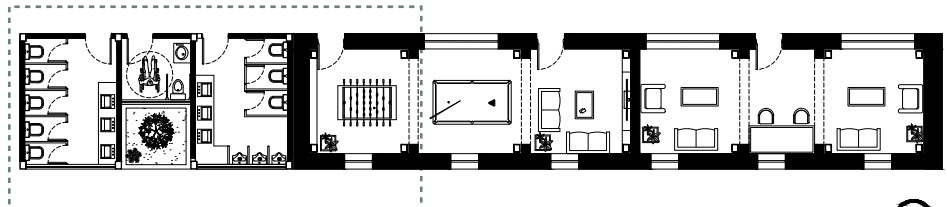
Planta arquitectónica baños públicos_ Bloque C.
